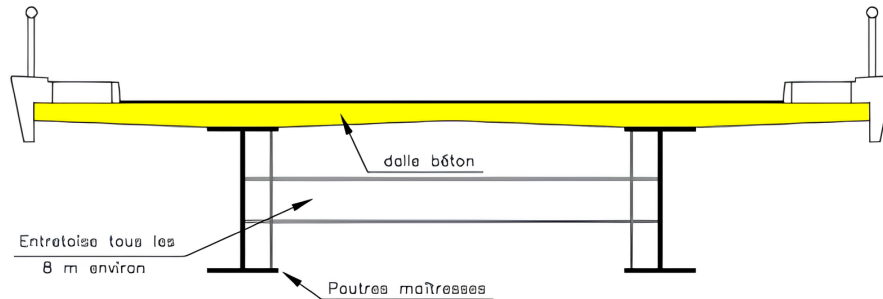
Ouvrage mixte bipoutre, ossature à entretoises [5].
